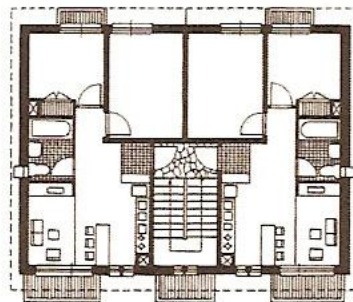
Grundriss eines Mehrfamilienhauses
